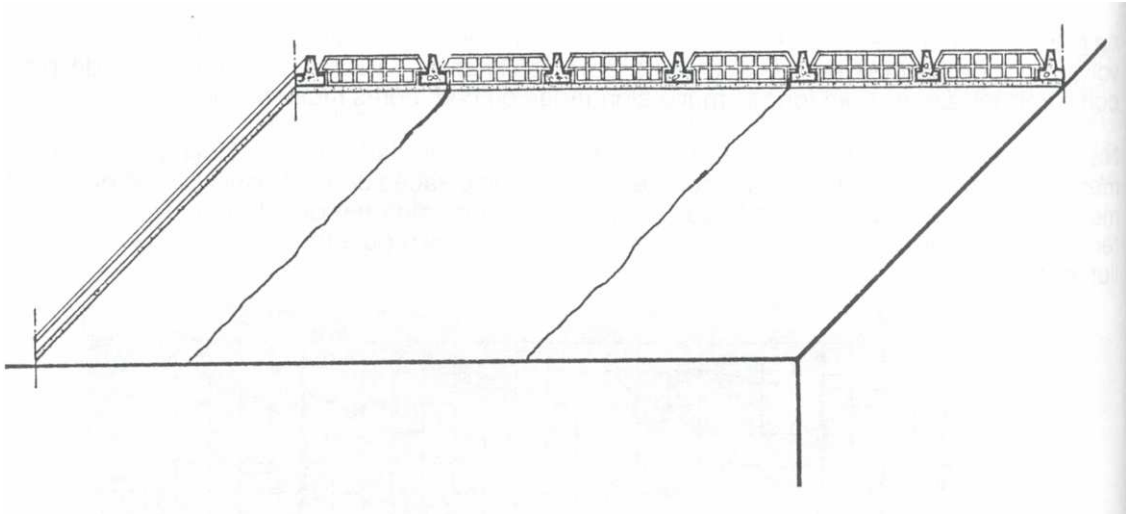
Fissuras provocadas por movimentações térmicas em forro constituído por laje mista.
